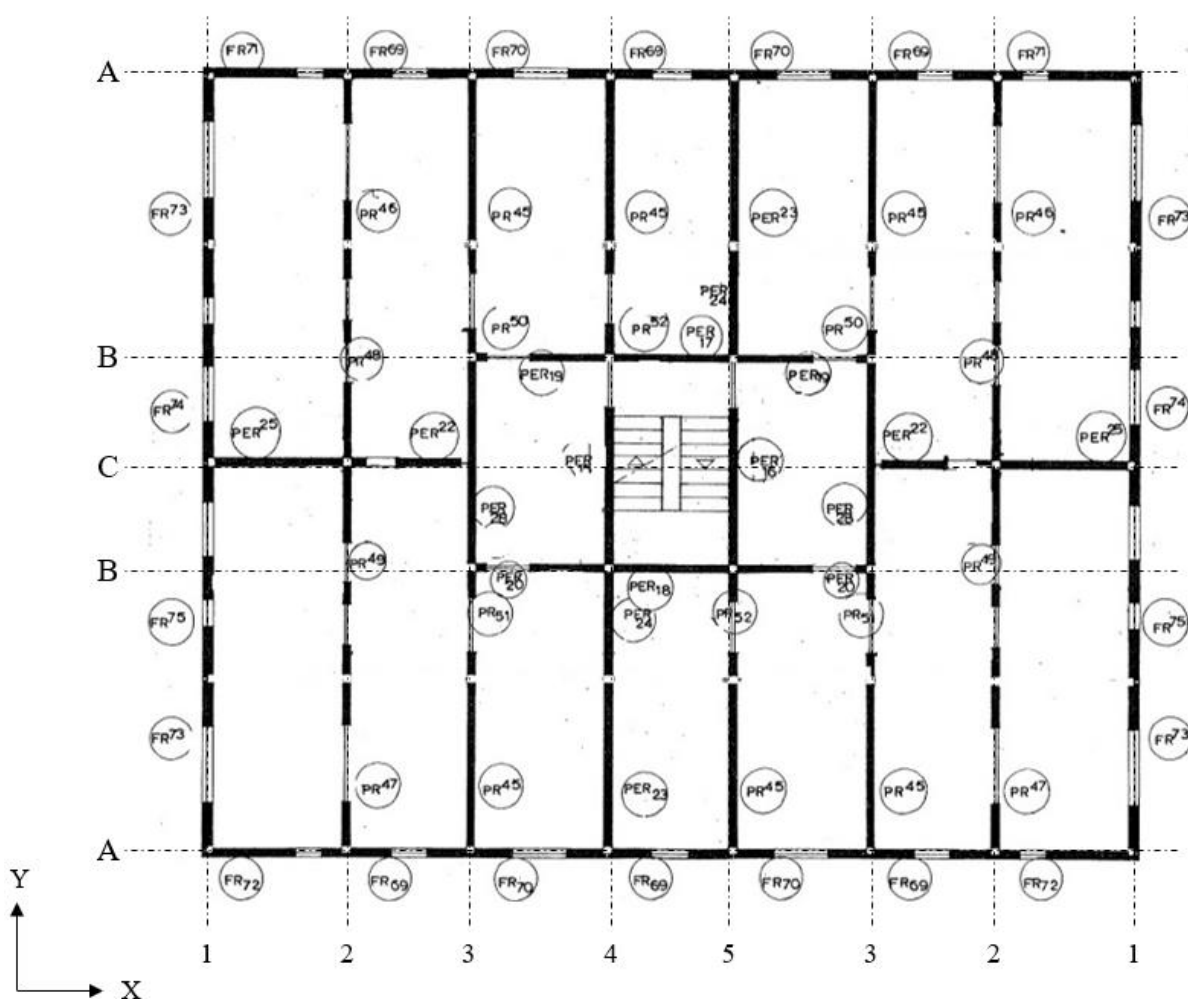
Distribuição dos painéis de parede estruturais em planta até ao 5º Piso (adaptado de (ICESA, 1974)).
